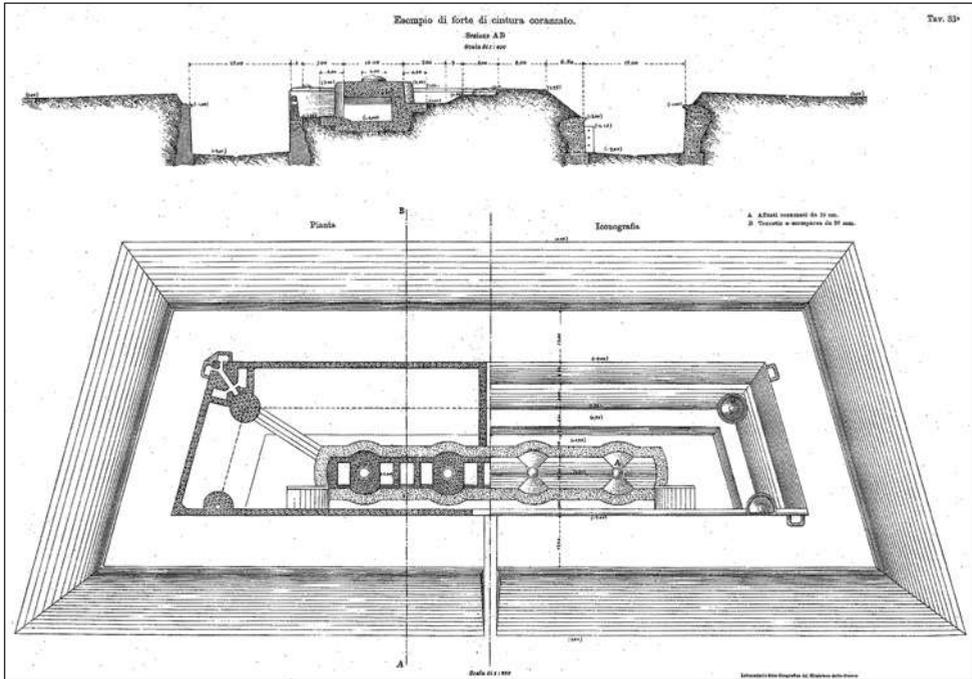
Esempio di forte di cintura corazzato tipo Rocchi, pianta e sezioni (da Rocchi 1902).
